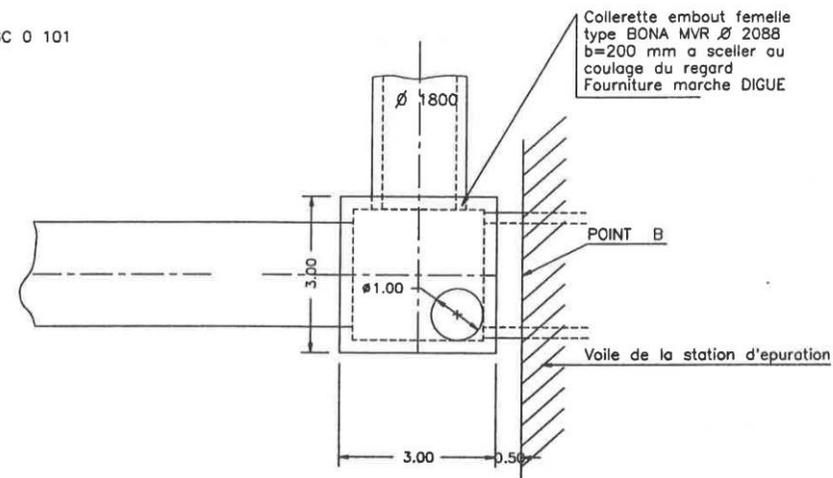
Vue en Plan chambre de Raccordement à Terre (source Plan d'exécution Émissaire sous digue SPADA 1993)
